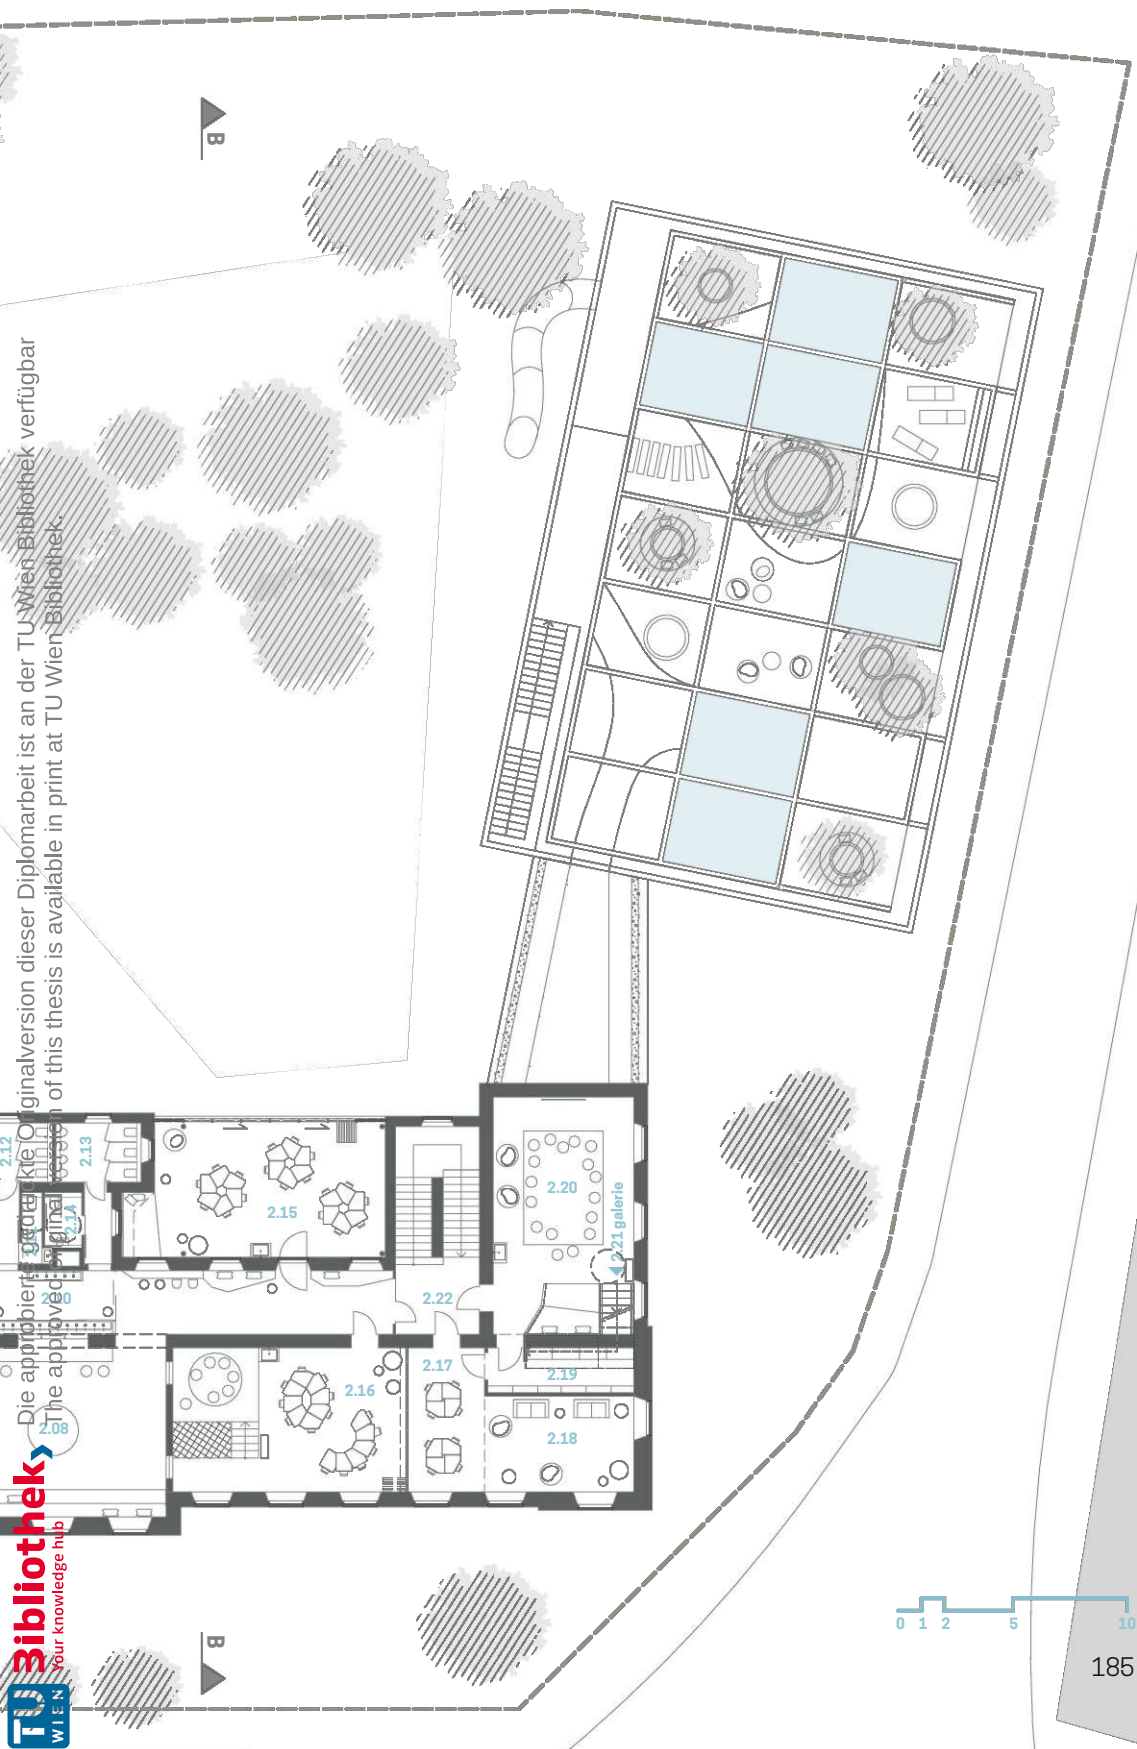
Grundriss 2. Obergeschoß.
